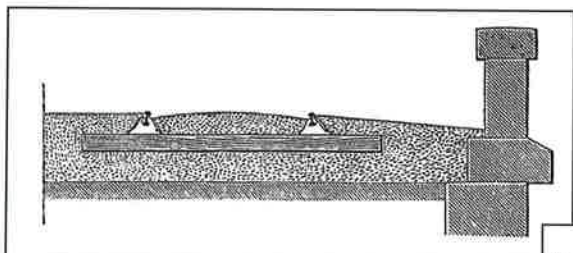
, échelle du plan : 15/1000. Profil de voie sur un ouvrage d'art.
